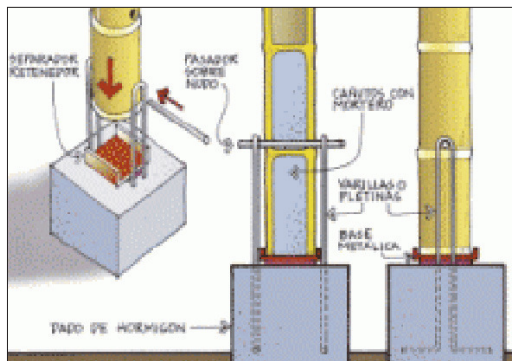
Sistema de estructuración de columnas de caña guadúa (Arquba, 2009, p. 22).
